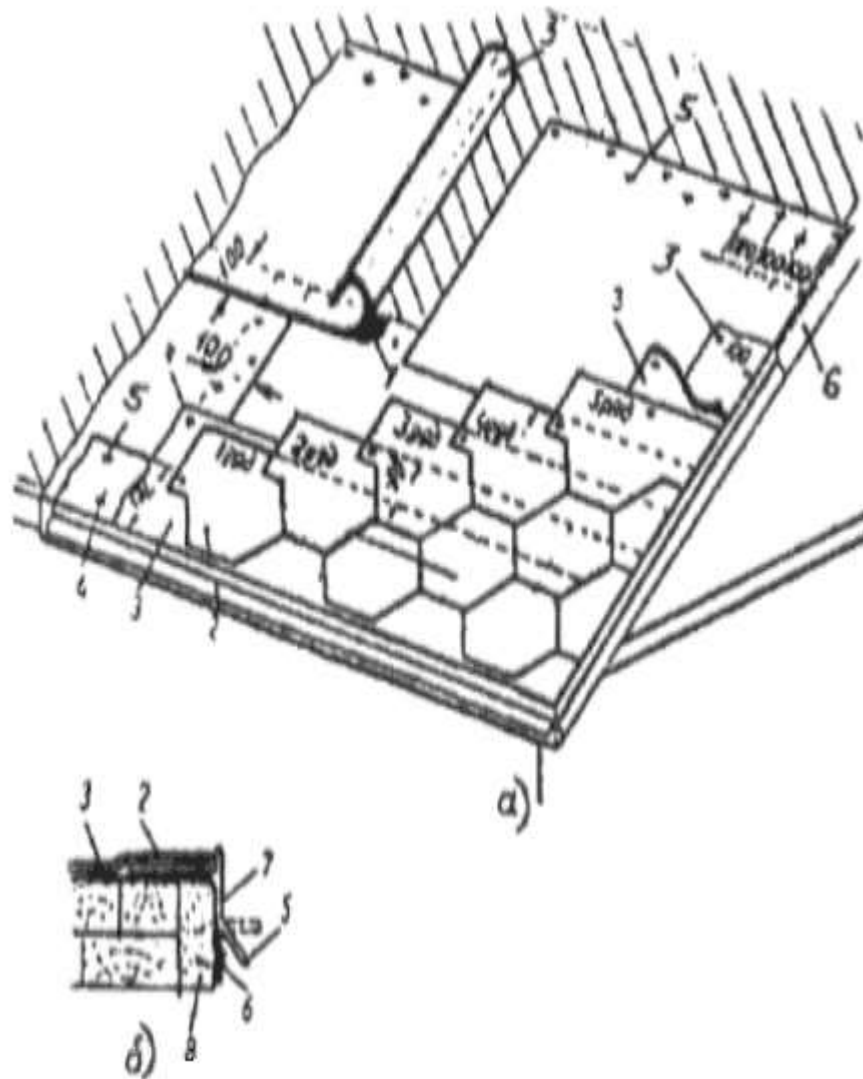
Конструктивное решение кровли из битумных плит Tegola
